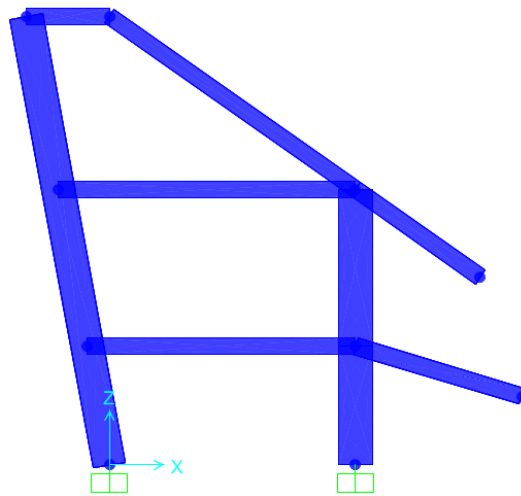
Pórtico tipo con 6 metros de distancia entre ejes de pilares. Longitud de voladizo superior: 3 metros. Longitud de voladizo inferior: 4 metros. Sección de hormigón armado rectangular de 30x40cm para las vigas y 80x40cm para los pilares.
